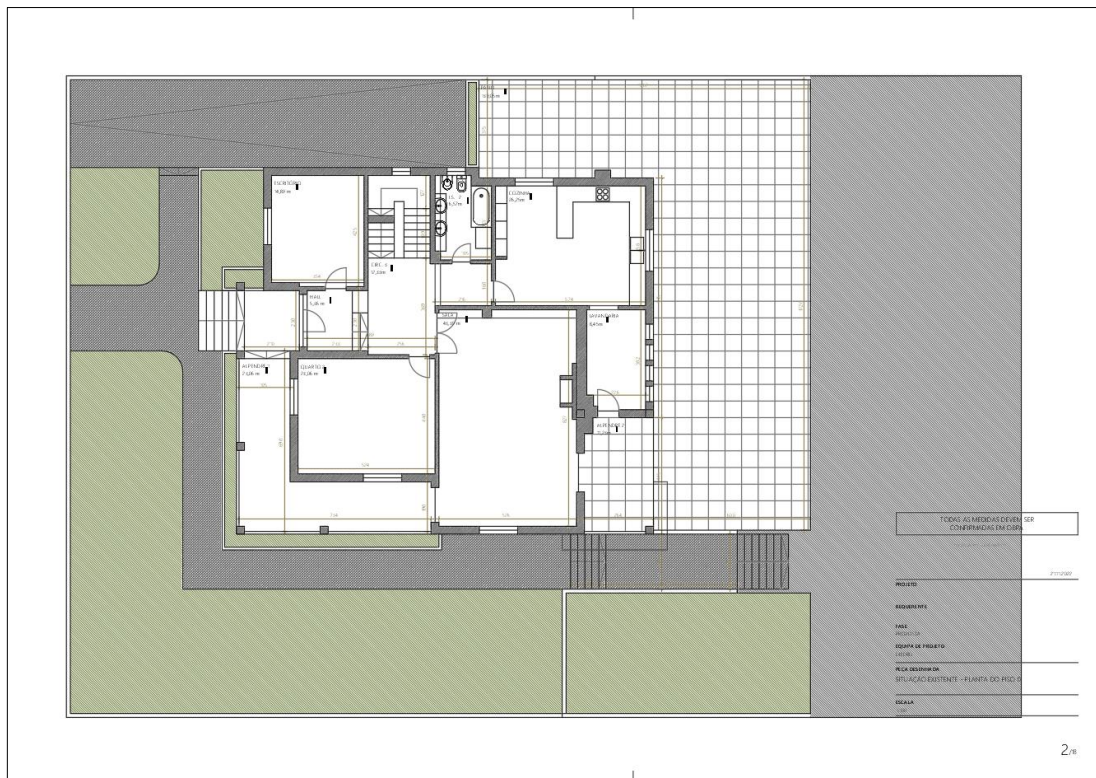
Planta existente (Fonte: Diedro, 2022)
